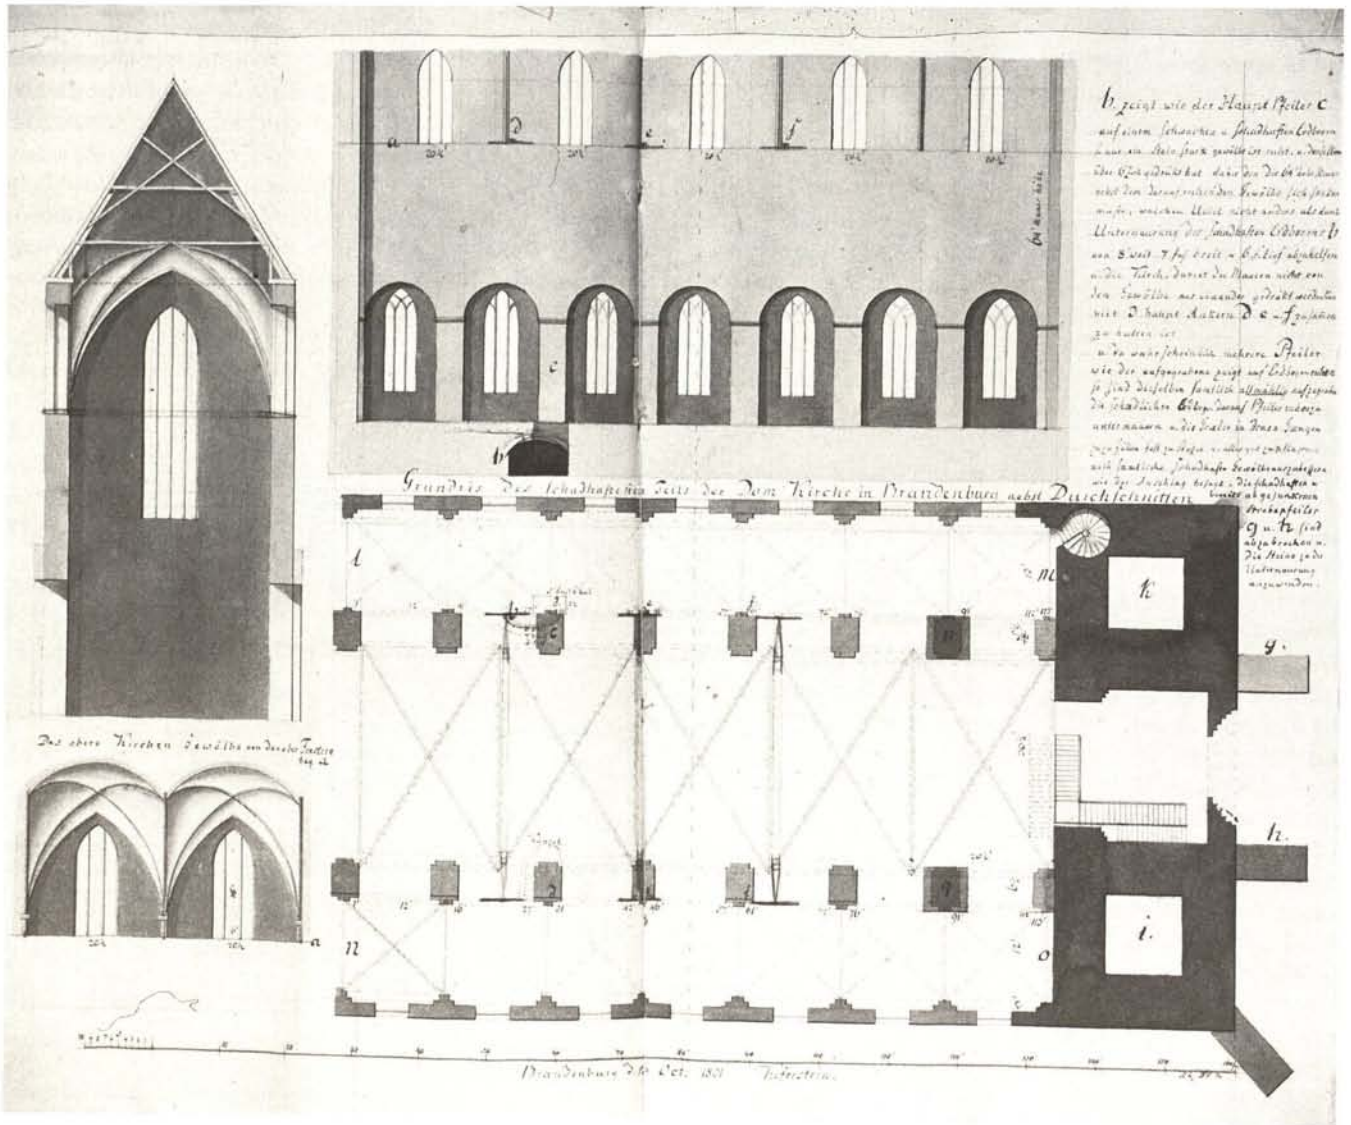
Dom zu Brandenburg, Längsschnitt mit Blick nach Süden, mit Eintragung eines damals ergrabenen eingedrückten Fundamentbogens, Querschnitt und Grundriß gemäß Kefenstein, 1801
